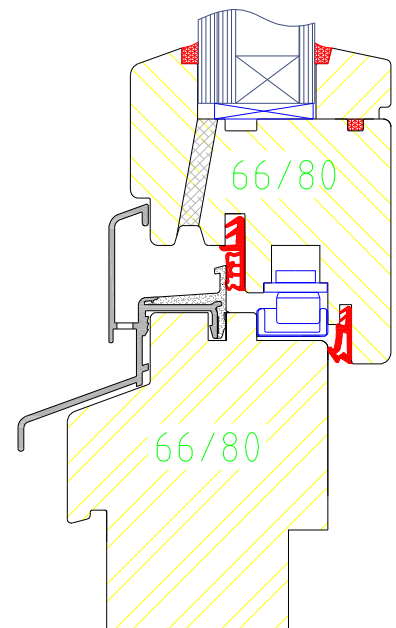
Traditionelle Fensterkonstruktion aufgerüstet gemäß neueren Erkenntnissen
